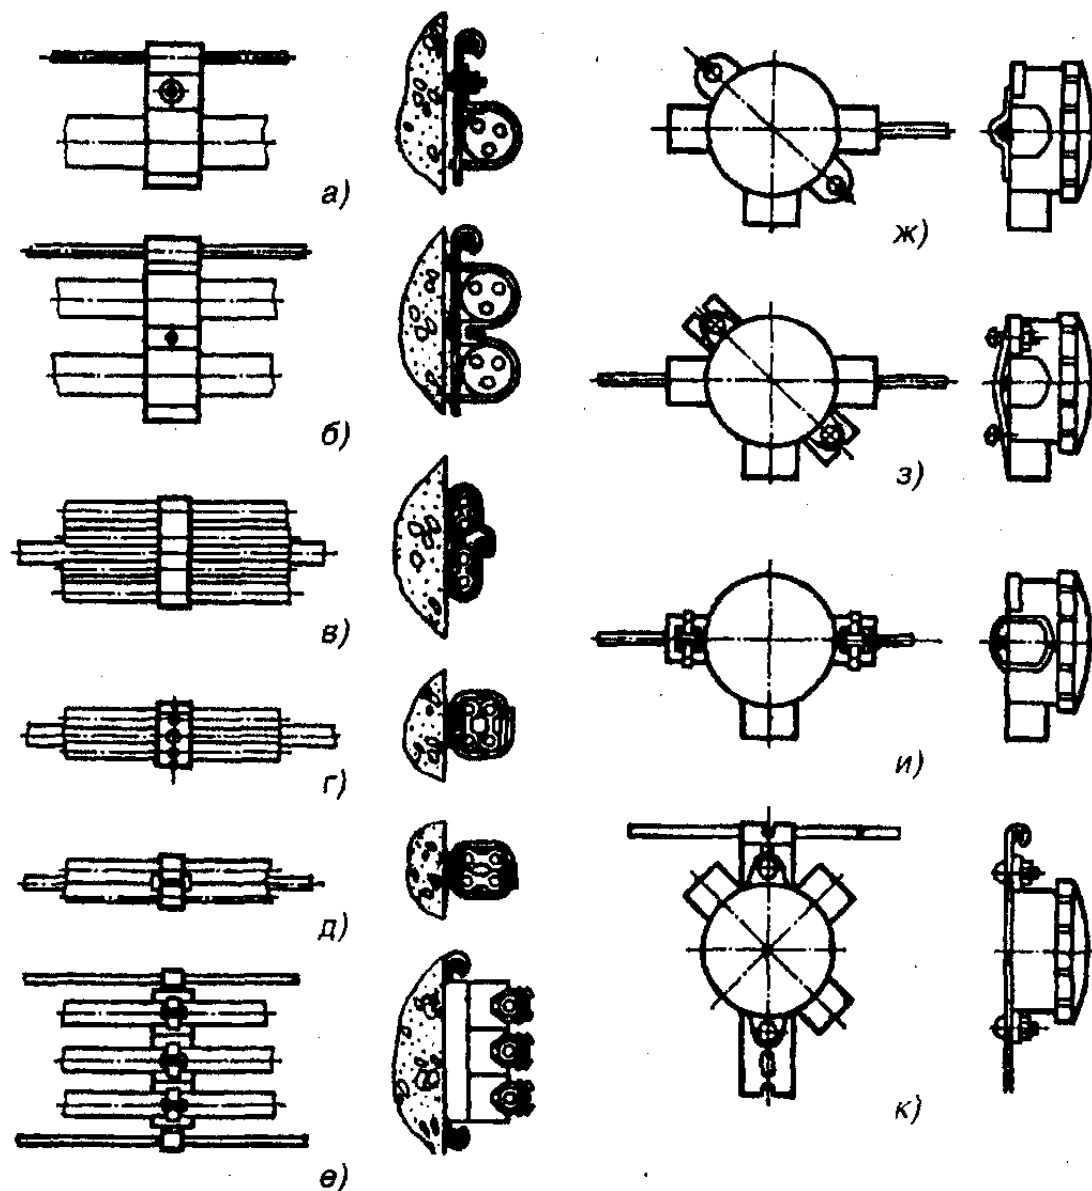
Прокладка кабеля и проводов по стене с креплением к струнам:
